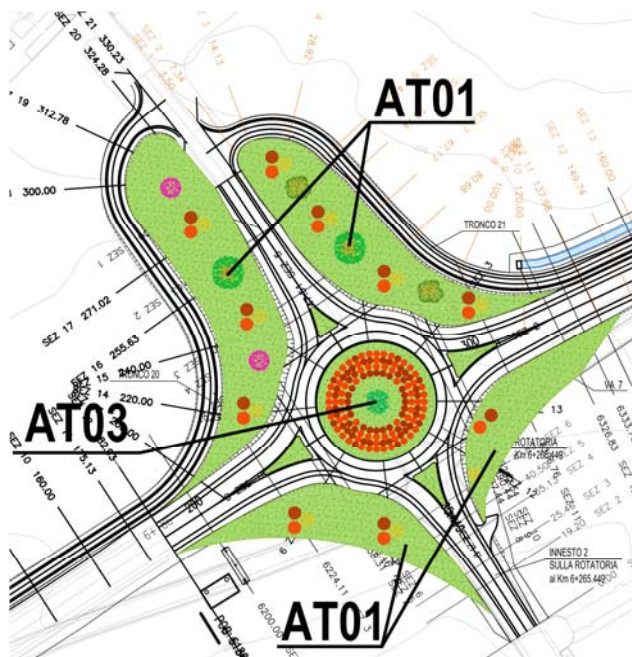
Stralcio planimetrico di una rotatoria di progetto
